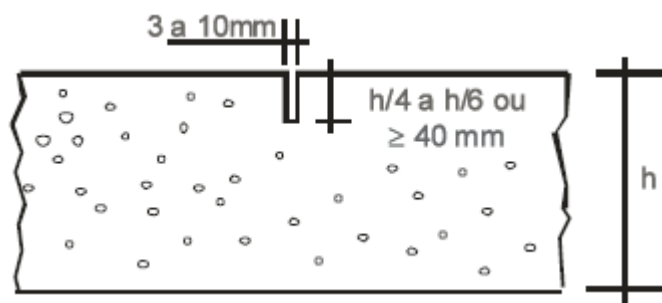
Exemplo de junta transversal de retração serrada. (Fonte: Manual de Pavimentação DNIT, 2004)
